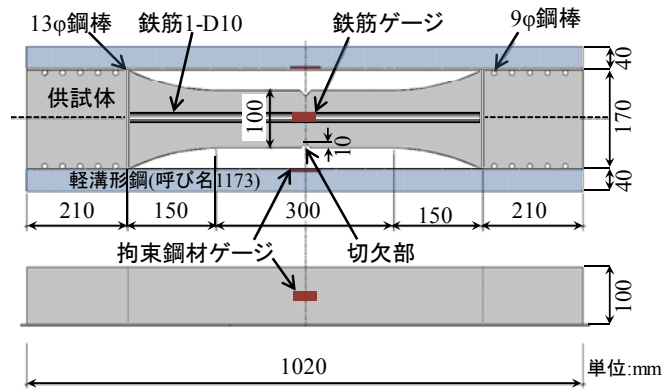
乾燥収縮ひび割れ試験体形状寸法
